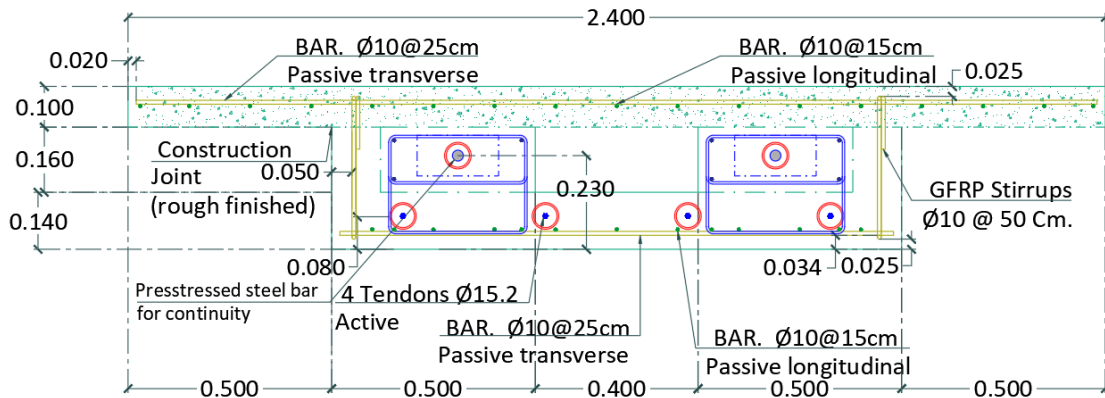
Sección transversal de la primera geometría proyectada
